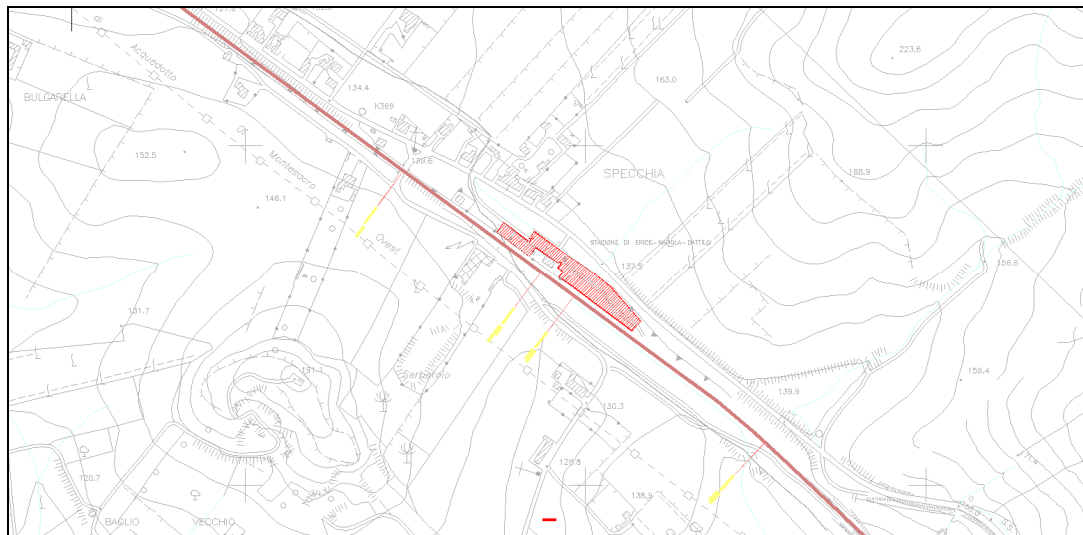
Cantiere operativo e cantiere base stazione di Ummari
